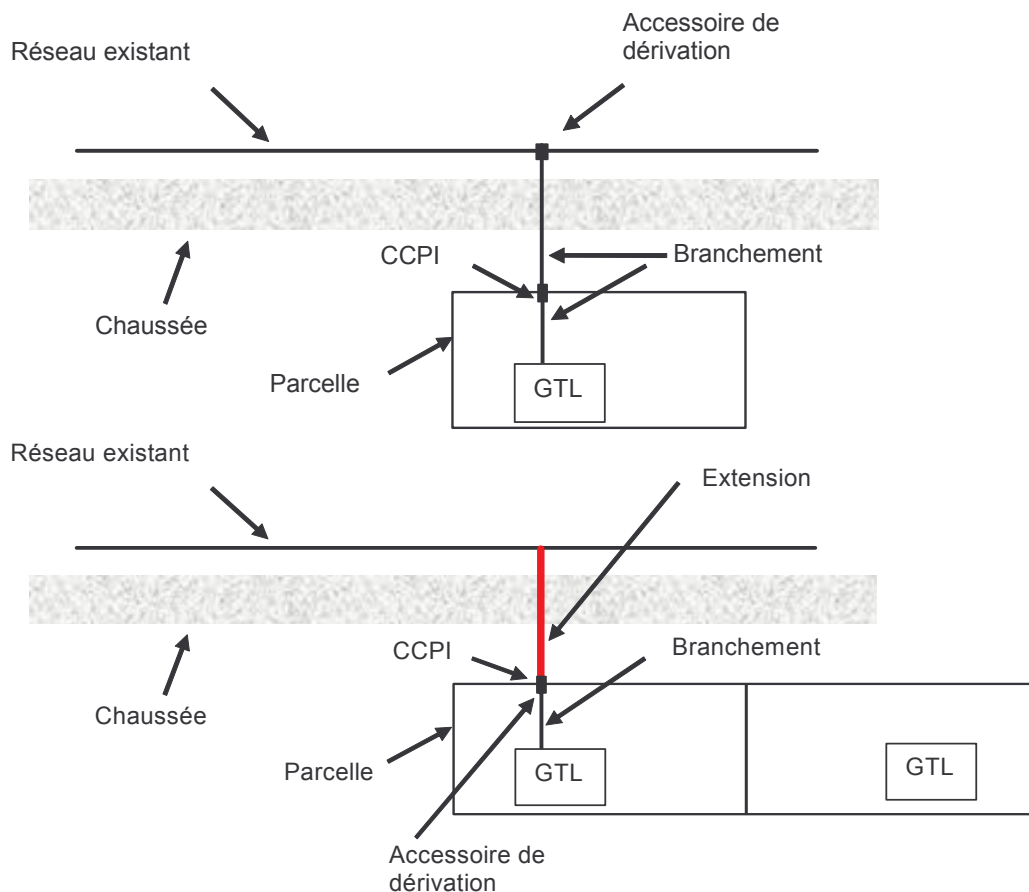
raccordement individuel BT ≤ 36 kVA avec traversée de chaussée
